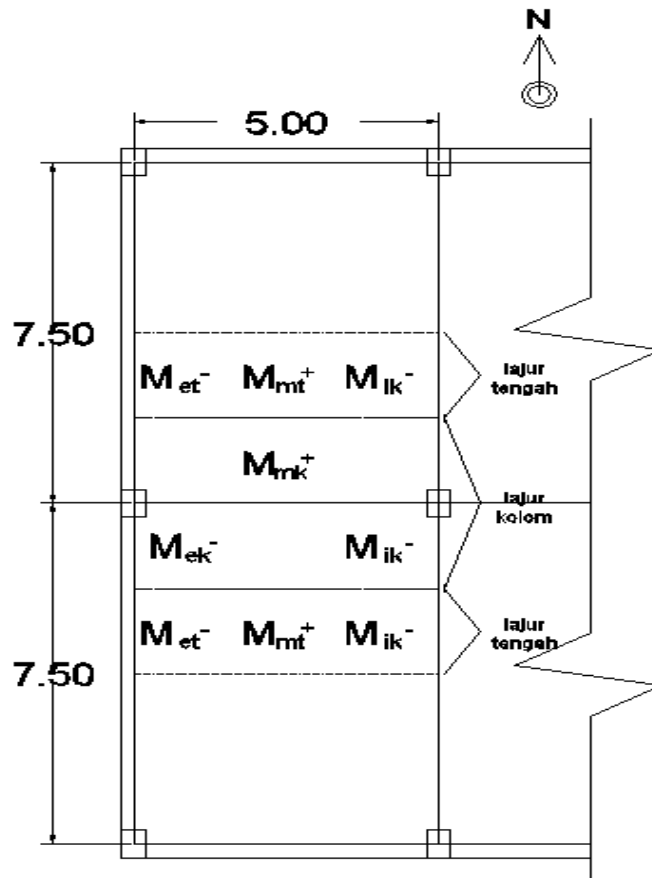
Ukuran Slab Pada Tipe A
